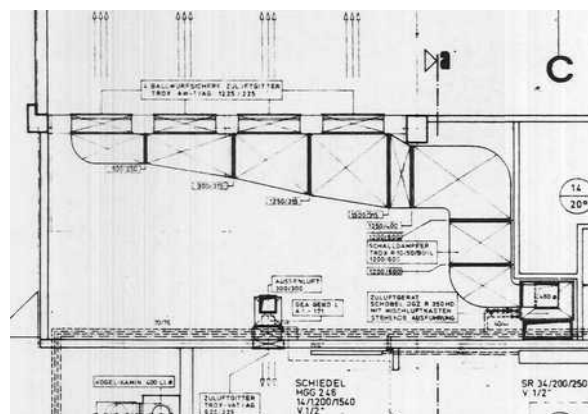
Grundriss einer Lüftungsanlage im Geräteraum
